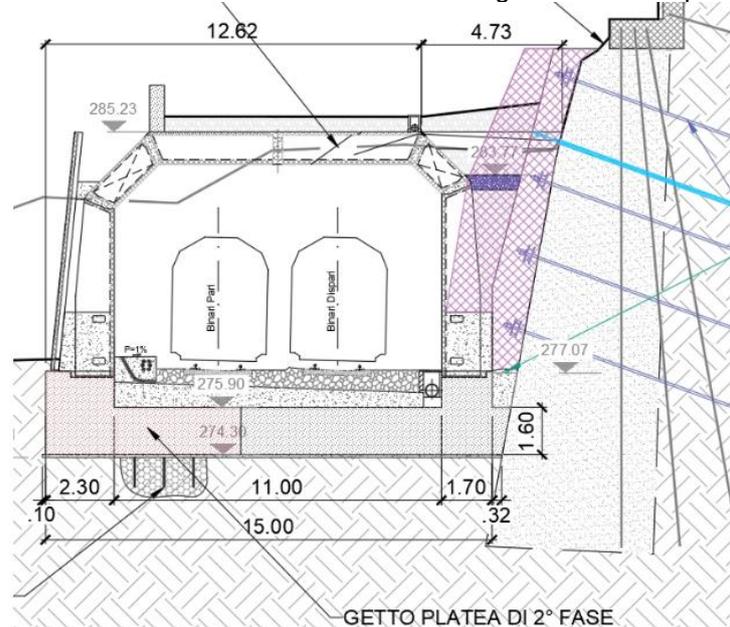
Sezione tipo dei contrafforti previsti lato Ovada.
